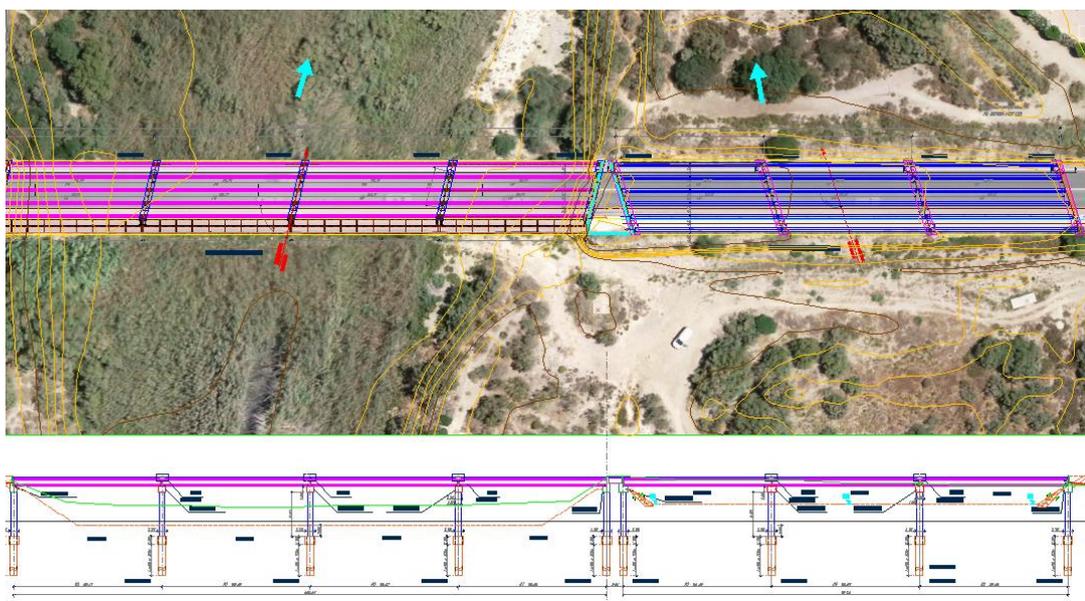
Planta y alzado del puente AL-7107, actual (magenta) y su ampliación (azul)
